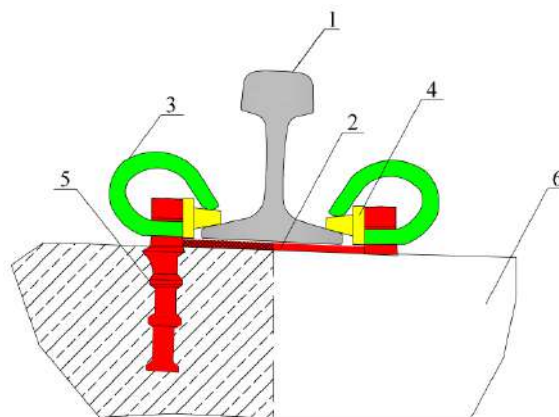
Общий вид рельсового промежуточного скрепления СБ-3:
